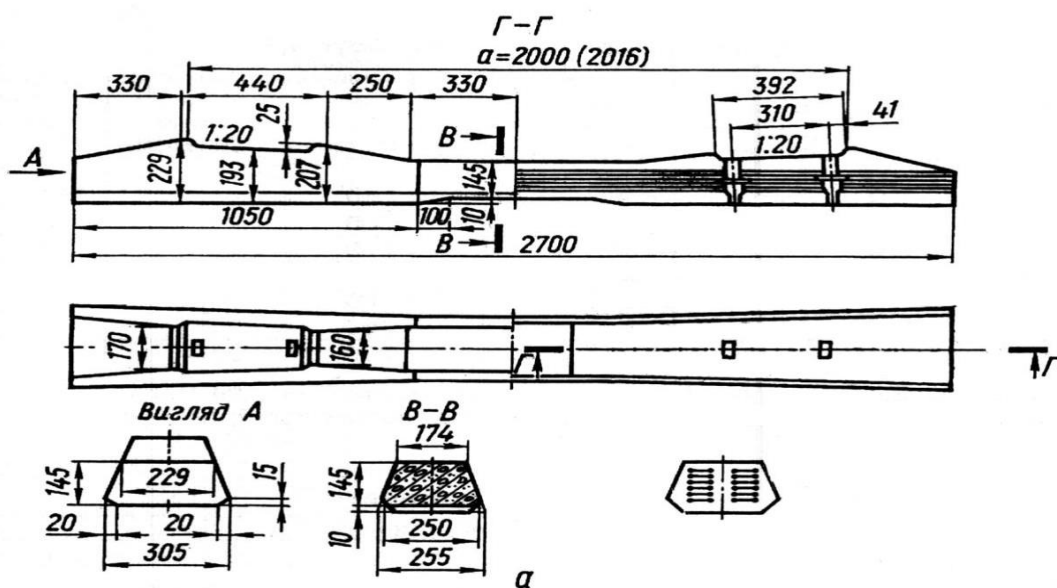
Попередньо напружені залізобетонні шпали типу Ш 1-1
